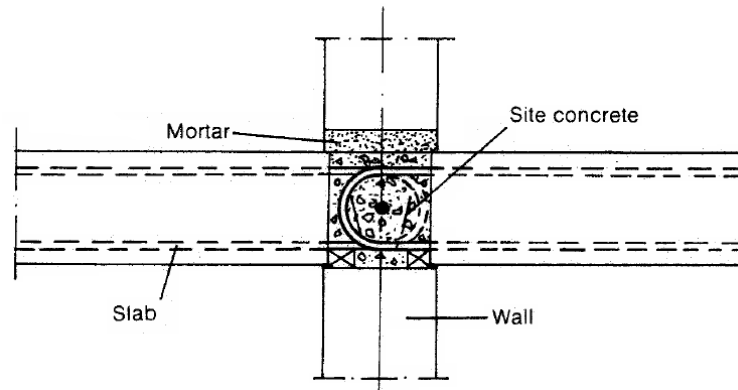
Ligação de tração com armadura de espera em nichos preenchidos com betão (Arnold, 2002)
